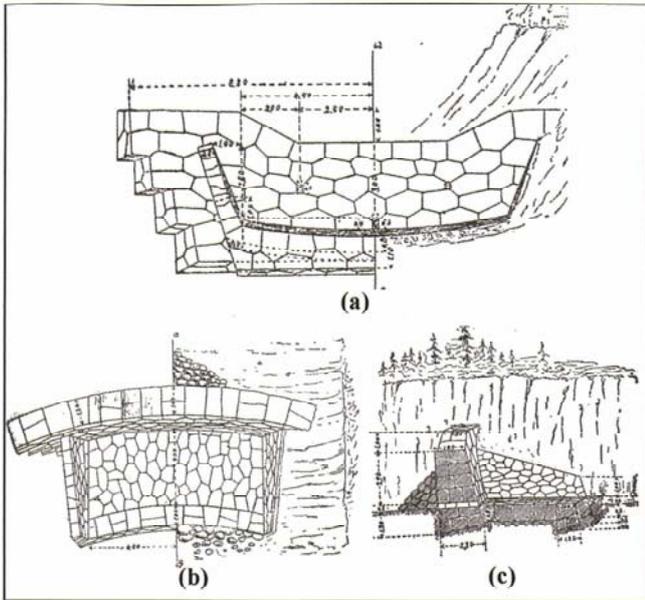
留学復命書に「ラコブニーク溪砂防工事」の工事雛型として示されている、石積堰堤の正面図(a)、平面図(b)、側面図(c)
